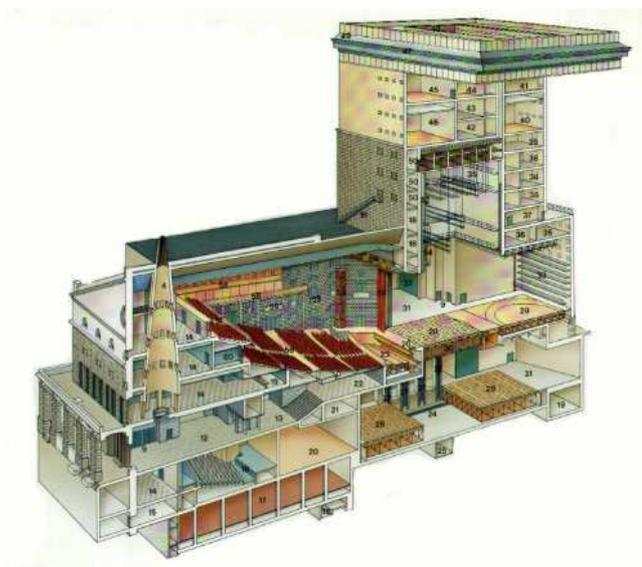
Vista di Sezione Teatro “Carlo Felice”.
